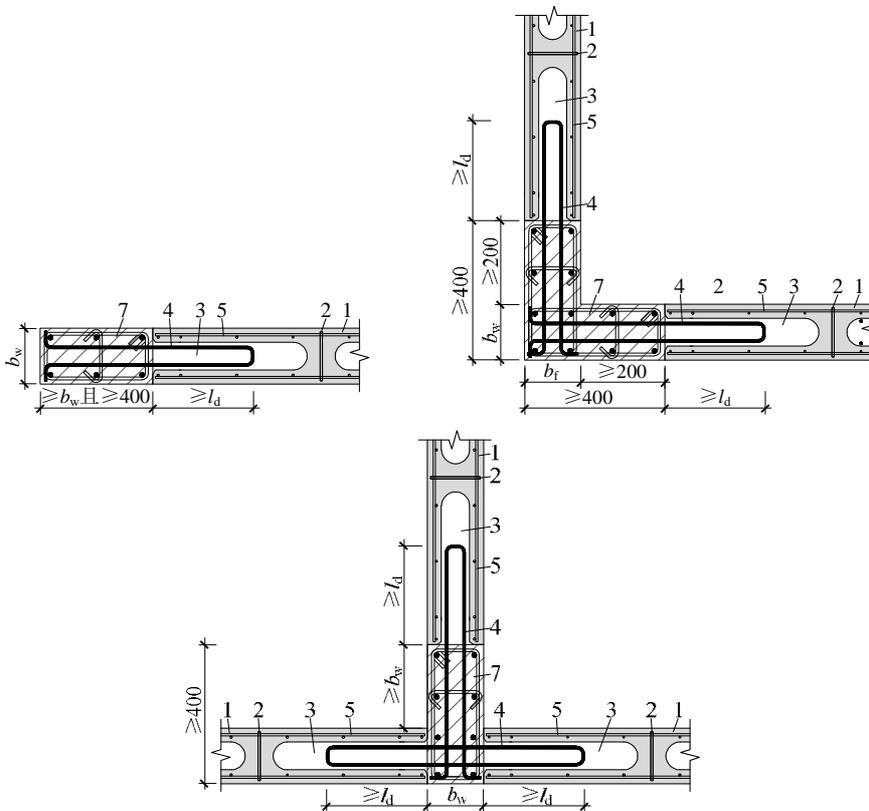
构造边缘构件区非边缘空心墙板水平连接构造示意
